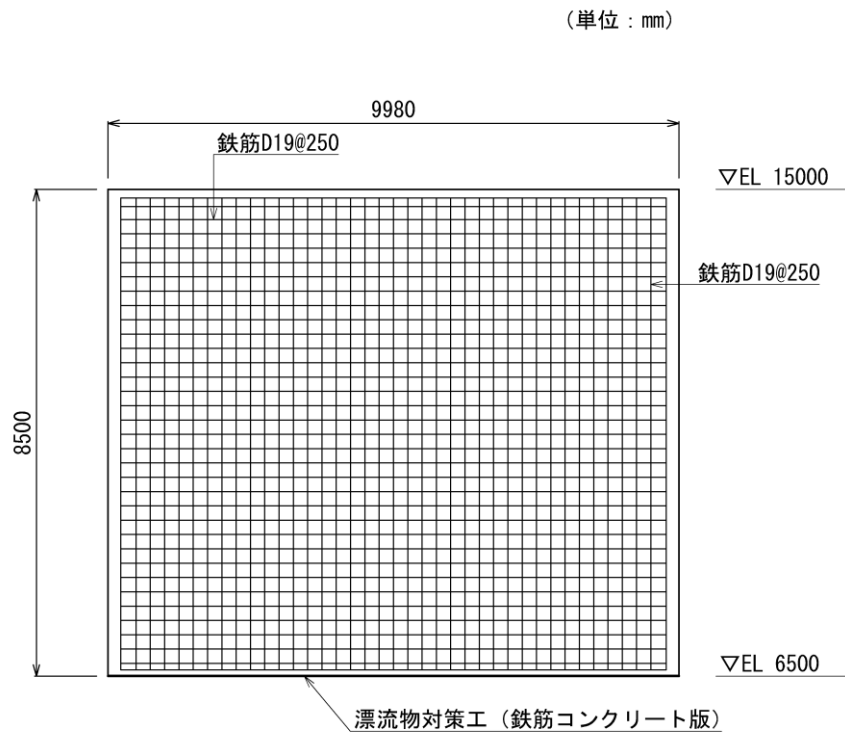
(1) 防波壁 (波返重力擁壁) 重力擁壁における漂流物対策工 (鉄筋コンクリート版) の概略配筋図 (正面図)
